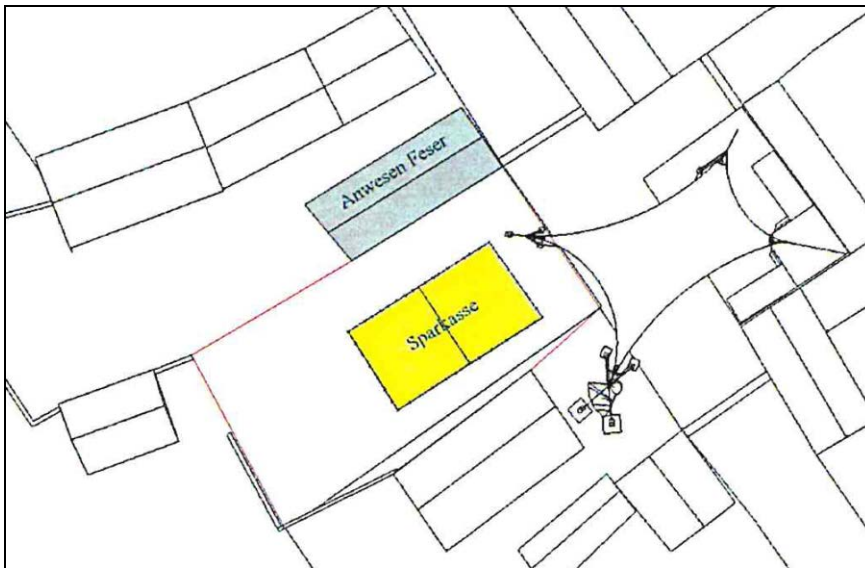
Bestandssituation vor Abriss (Quelle: Architekturbüro Reinhold Gallé) (unmaßstäbliche Darstellung)
